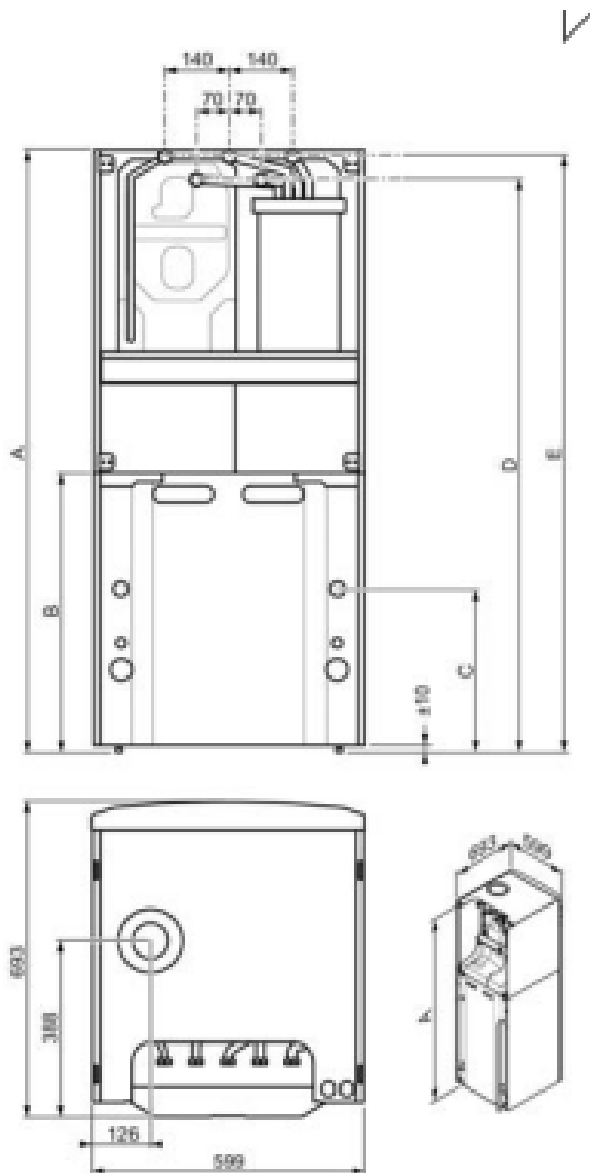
Dimensiones caldera. Fuente: <https://www.saunierduval.es/>
